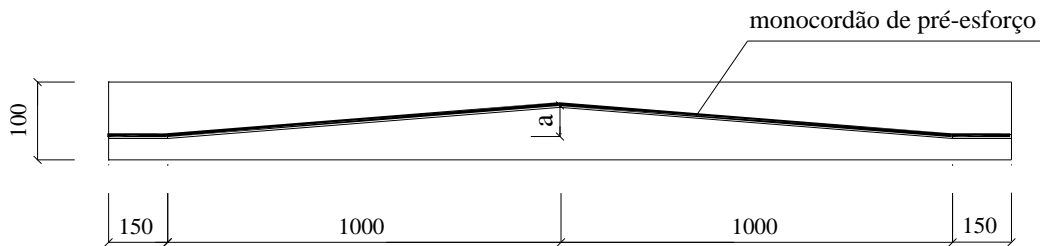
Traçado transversal trapezoidal [229] (desenho sem escala e dimensões em mm).
